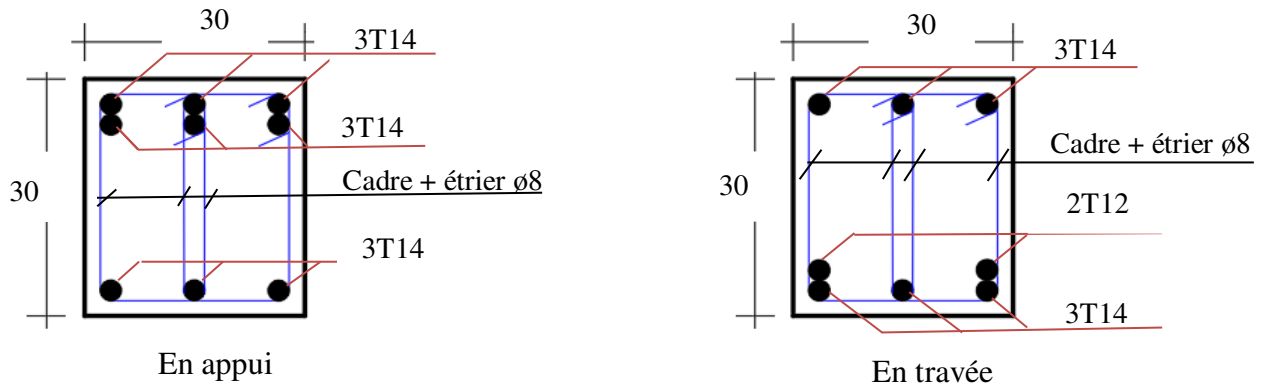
Ferrailage de la poutre secondaire en travée et en appui.
